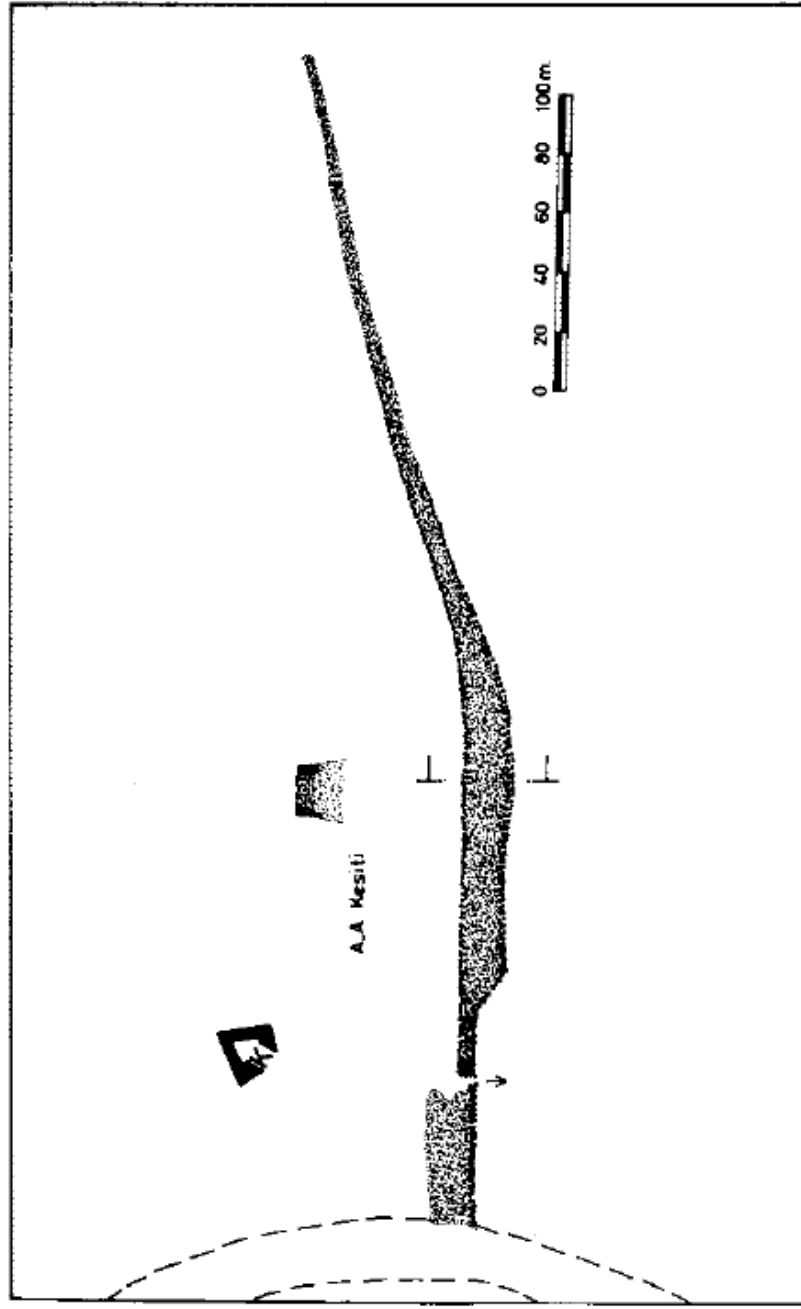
Karakuyu barajının planı (Bildirici, 2008)
